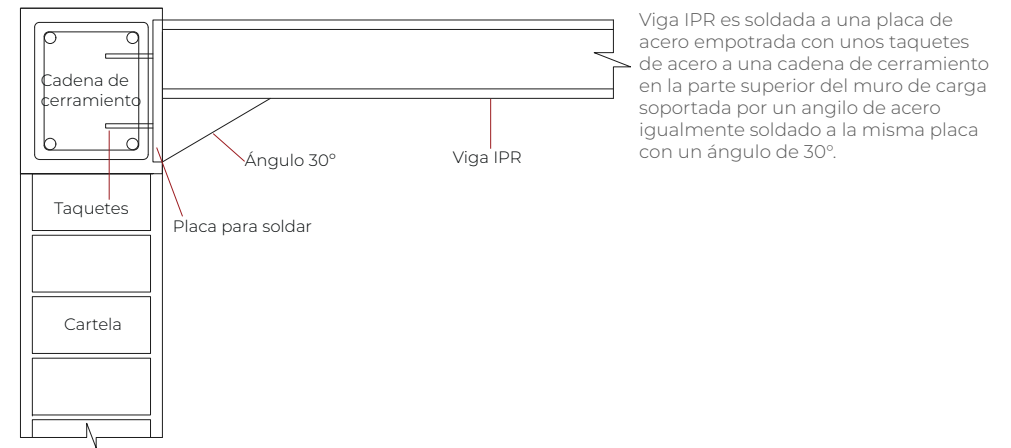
Detalle constructivo de anclaje de viga de acero a muro de carga cartela.
